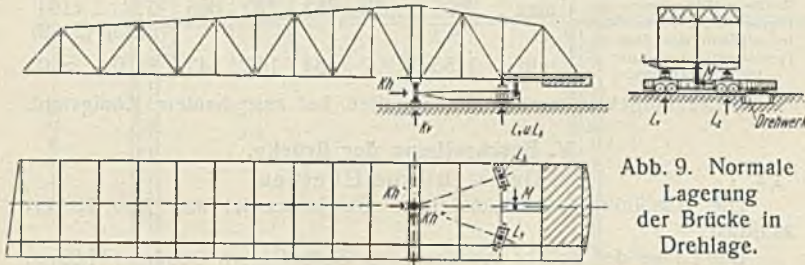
Normale Lagerung der Brücke in Drehlage.
